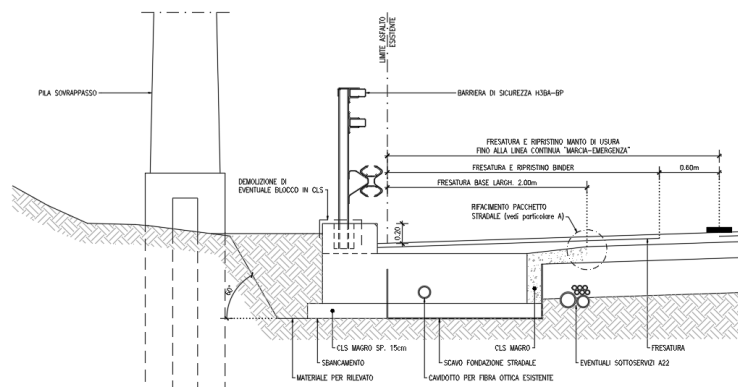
Sezione cordolo per la protezione delle pile dei sovrappassi
